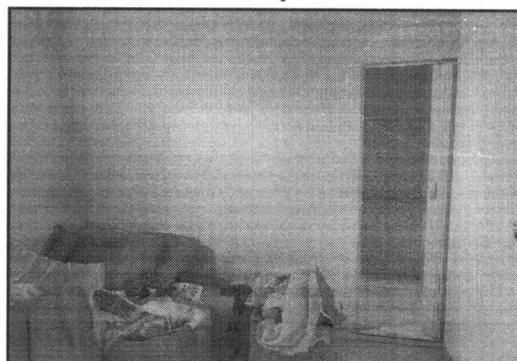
Imagem de Sala para depósito, com banheiro, no pavimento térreo
